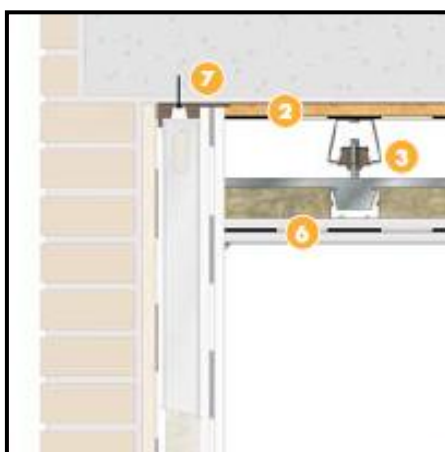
Encuentro pared-techo. (2) Aislamiento multicapa. (3) Amortiguador caucho ARC-25. (6) Sándwich acústico: 2 placas de yeso laminar N13 + Membrana Acústica Danosa M.A.D.4. (7) Sujeción elástica SEB-40.
